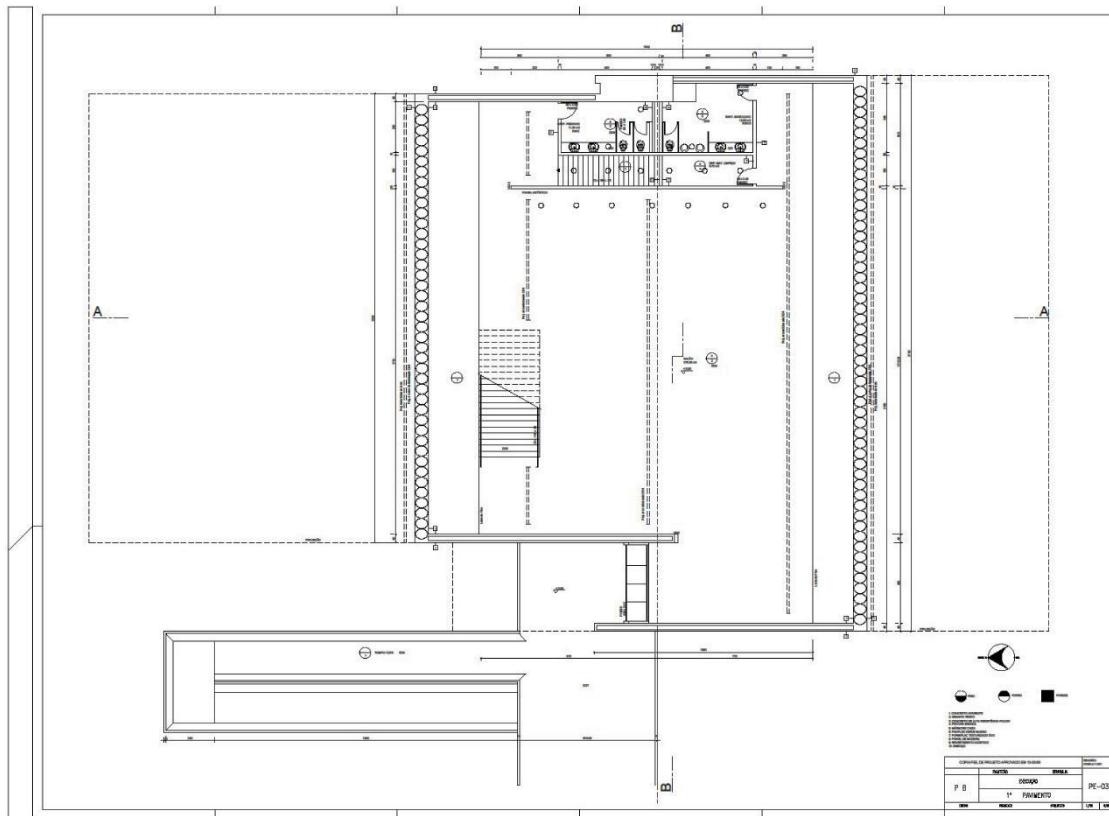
Set. 1985 – Panteão Brasília. PB PE-03. Escala 1:50. Execução – 1º Pavimento. O.N. Arquiteto (Cópia fiel do projeto aprovado em 13-08-86). Arquivo: PE-03.DWG Fonte: SUPAC/SECULT-DF
